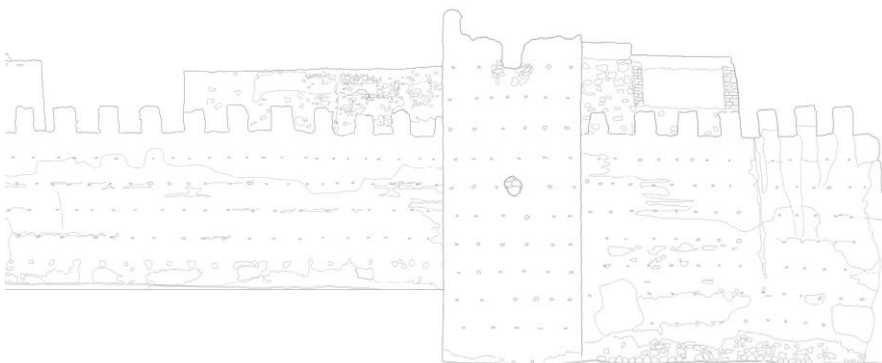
Alzado Norte TD y L4. Escala 1/200. Fuente: Autora.
